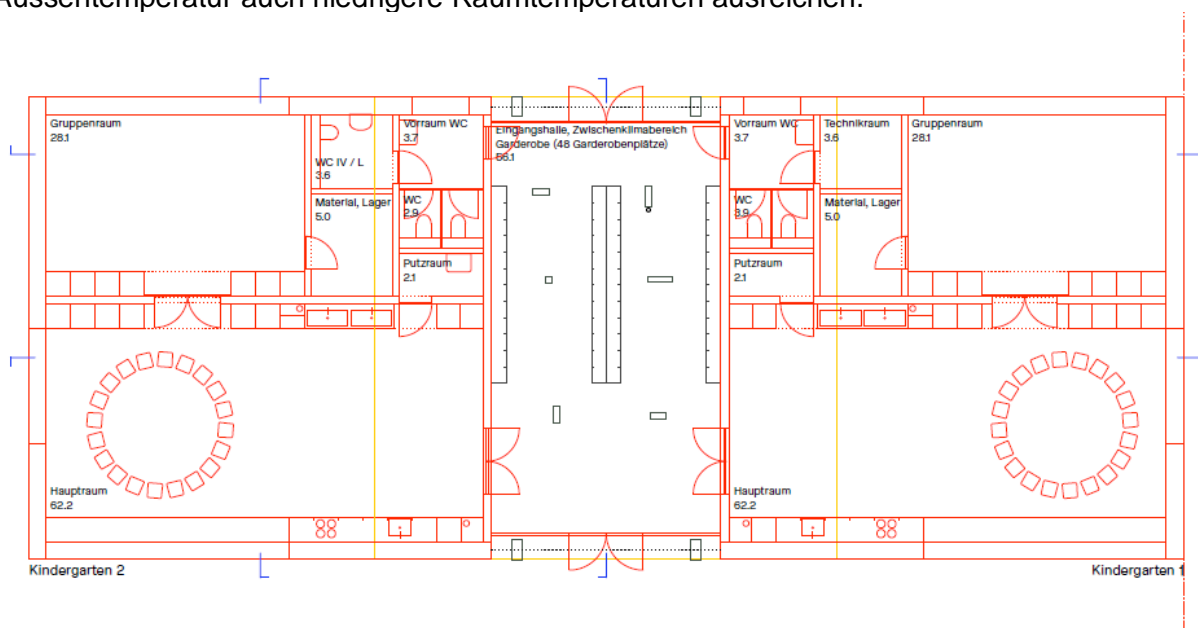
Grundriss Doppelkindergarten mit zentralem, vielfältig nutzbarem Vierjahreszeiten-Zimmer
